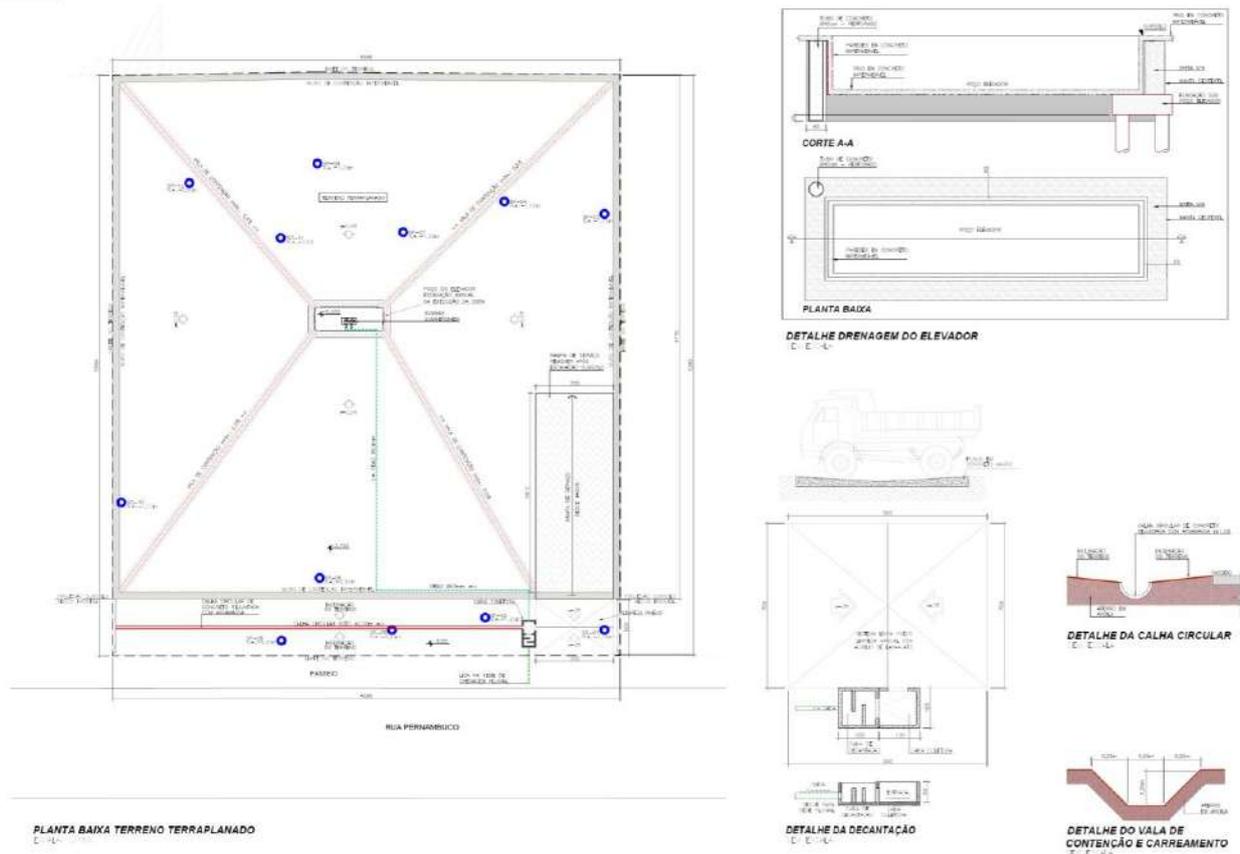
Planta baixa drenagem. FONTE: Projeto de Terraplanagem 2P Engenharia.
